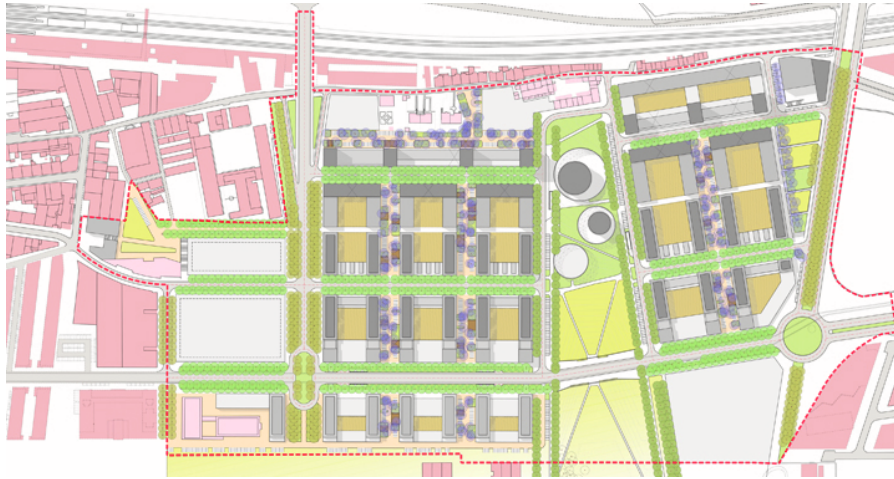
| Planta de Implantação da proposta, in (RISCO, 2011)
